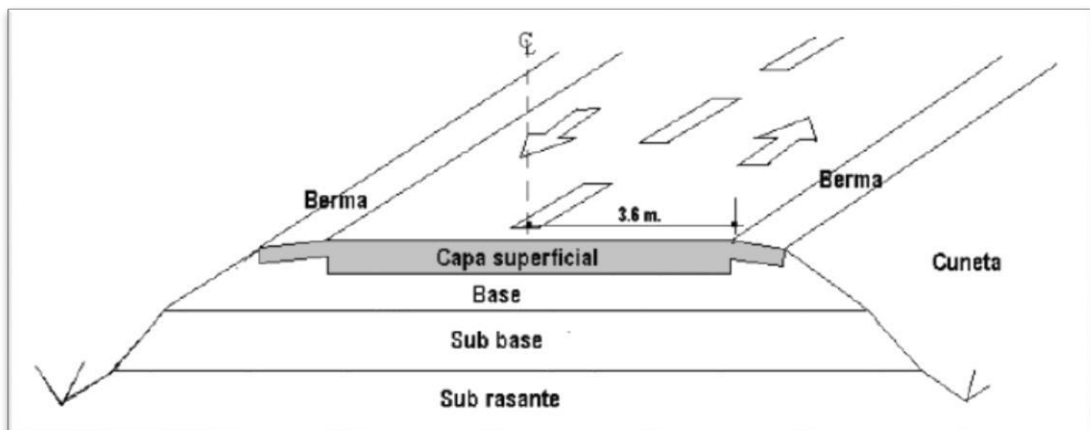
Estructura típica de un pavimento asfáltico (flexible)
